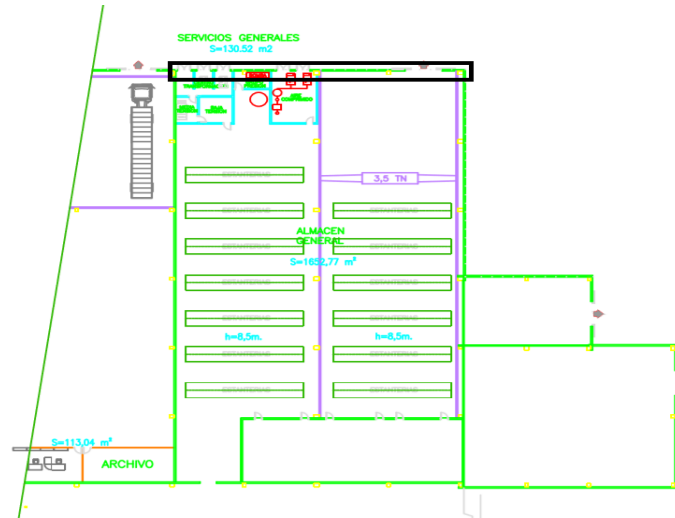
Existencia de zonas de succión severa en fachada lateral
